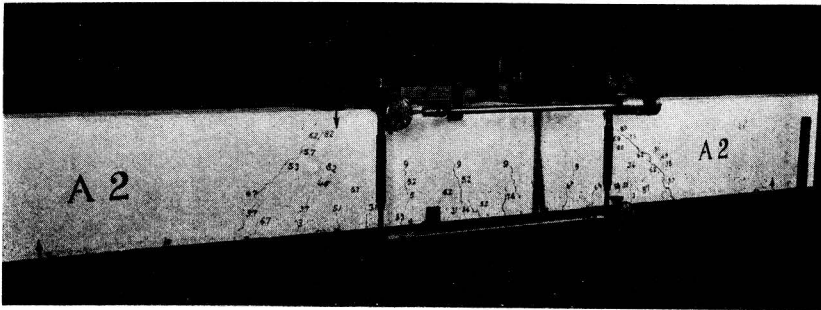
Rissbildung des Balkens A2 nach dem Belastungsfall VII.
